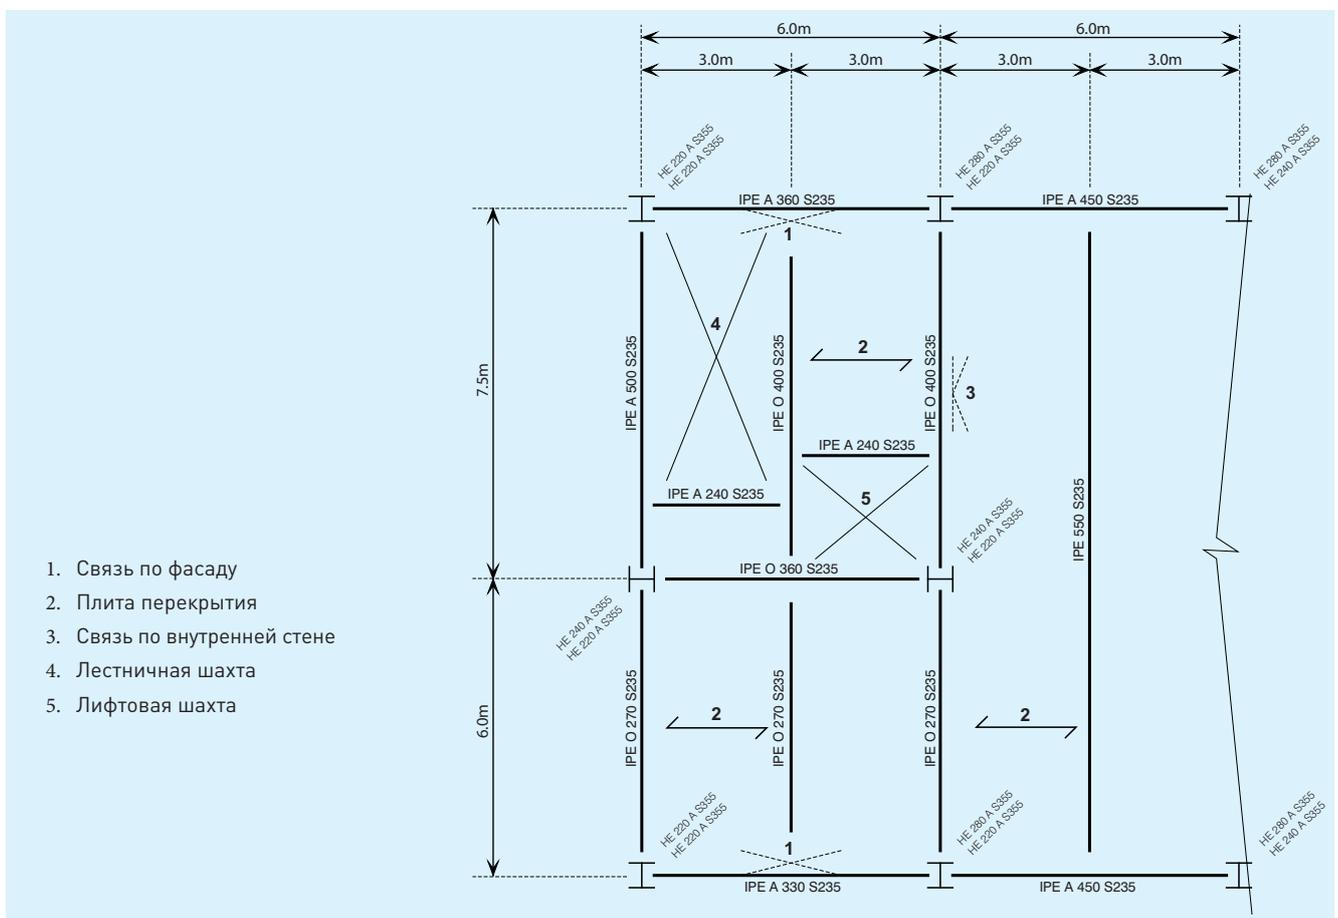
Схема расположения конструктивных элементов несущего каркаса здания с большепролетными балками
